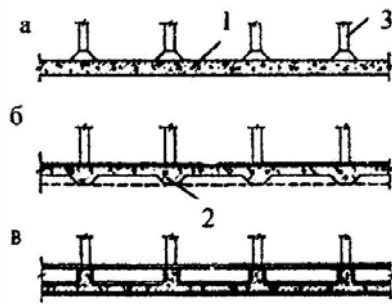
Плитні фундаменти (розрізи):
